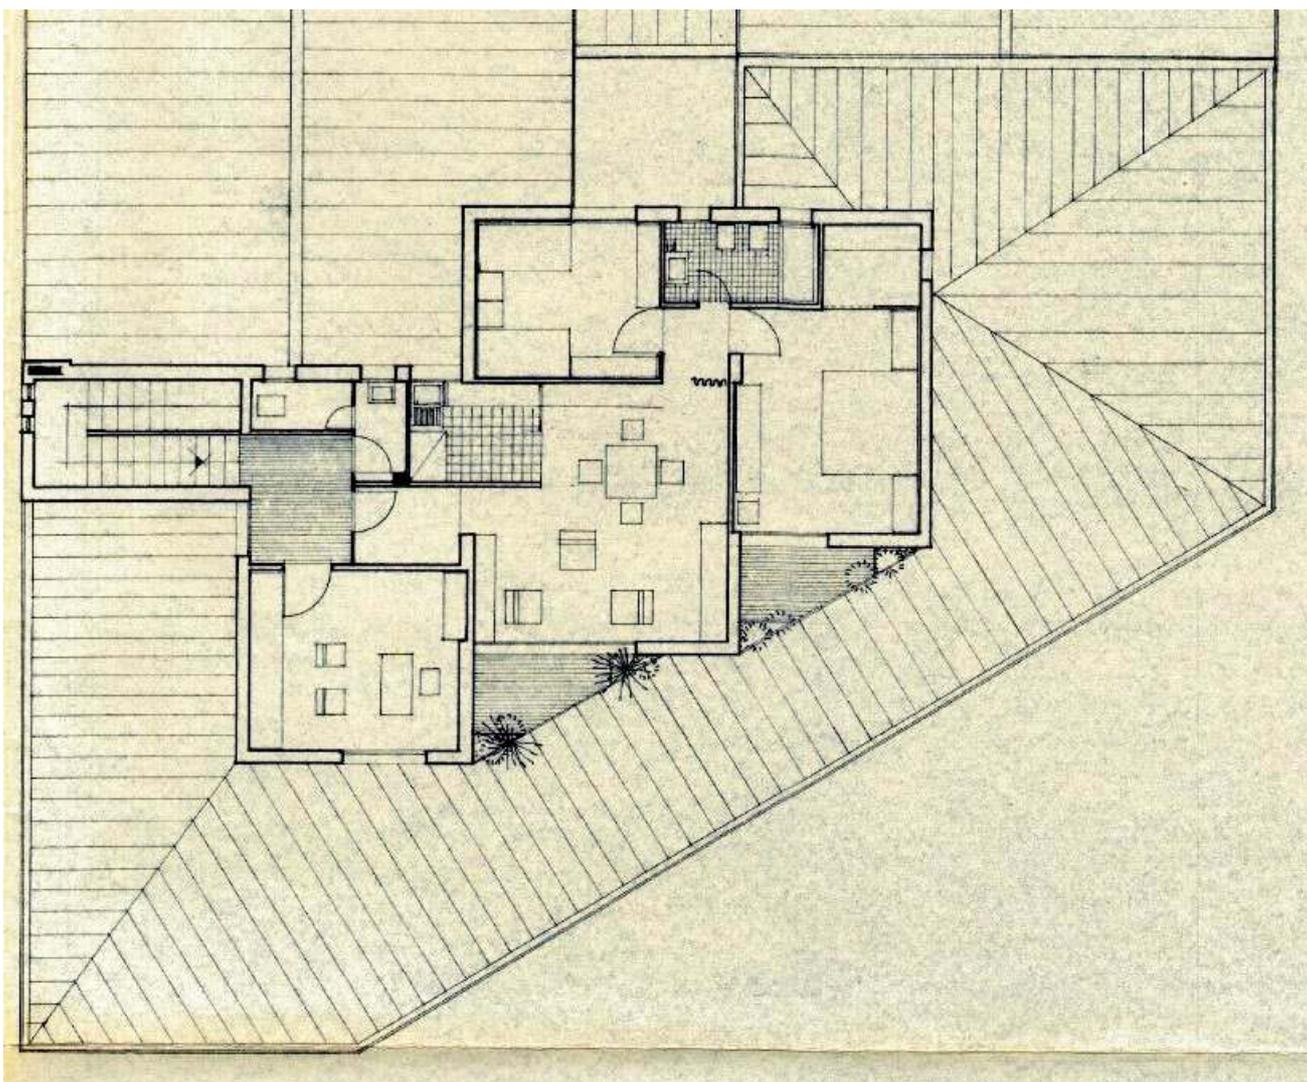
pianta piano terra con porzioni condonate (*fuori scala*)
